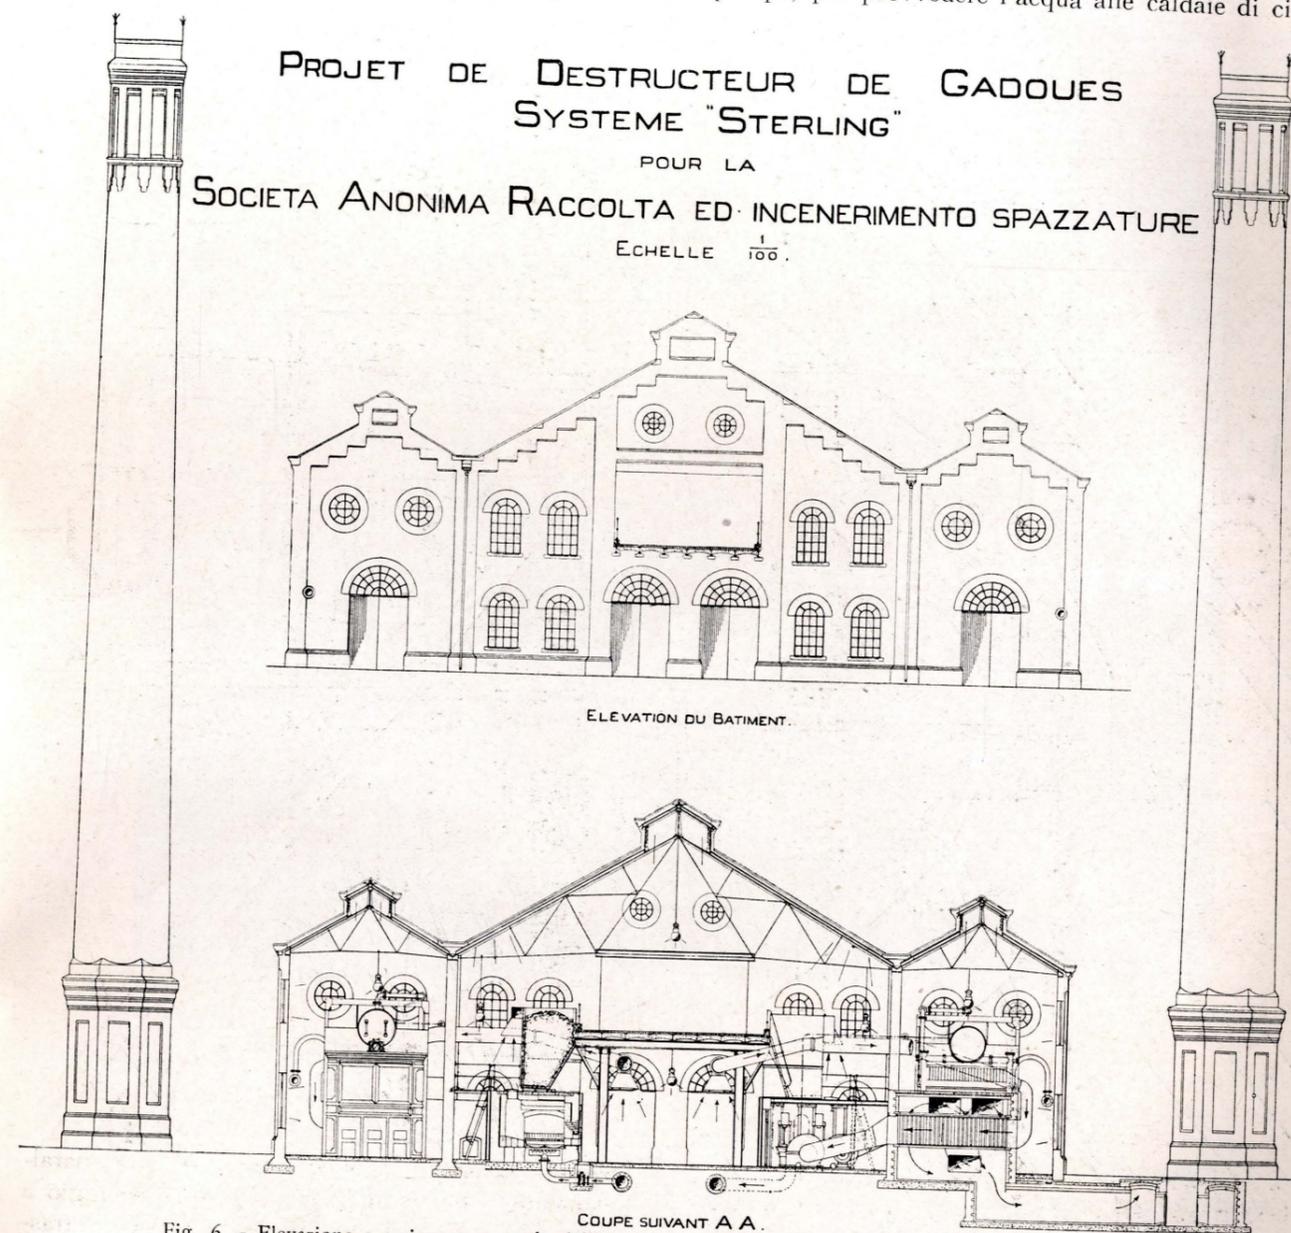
Elevazione e sezione trasversale dell'impianto di forni « Sterling » nel progetto per Torino.
